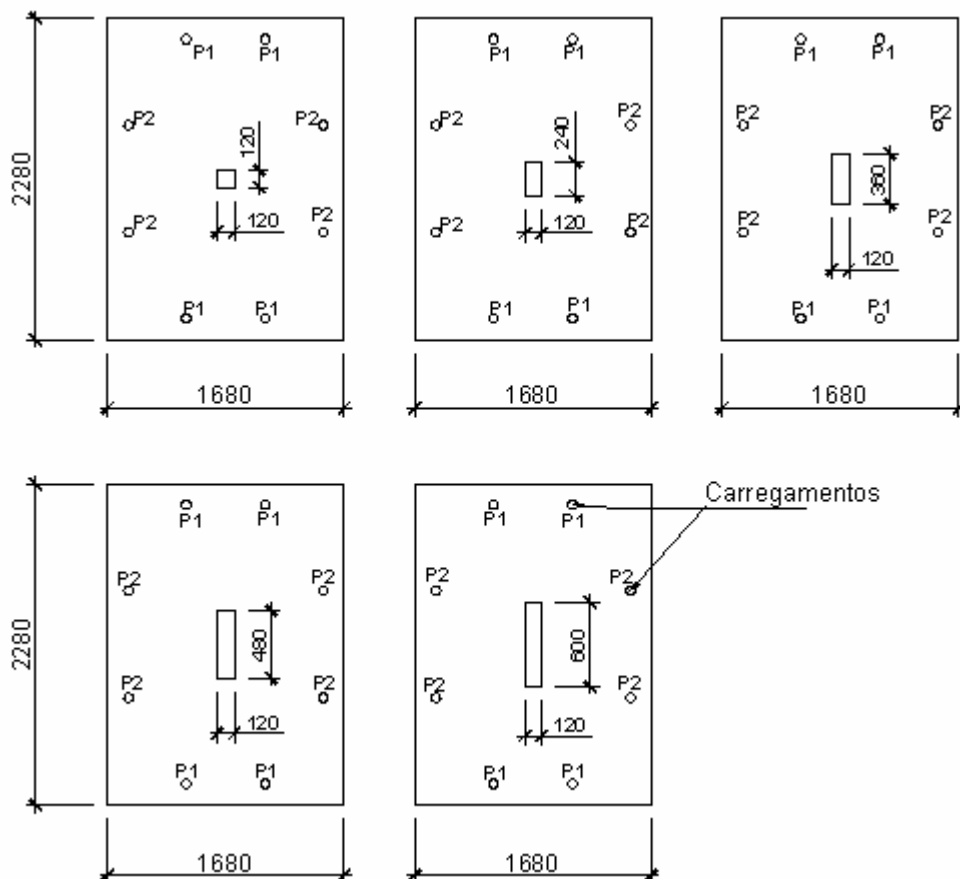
Lajes ensaiadas por Oliveira (2003)
